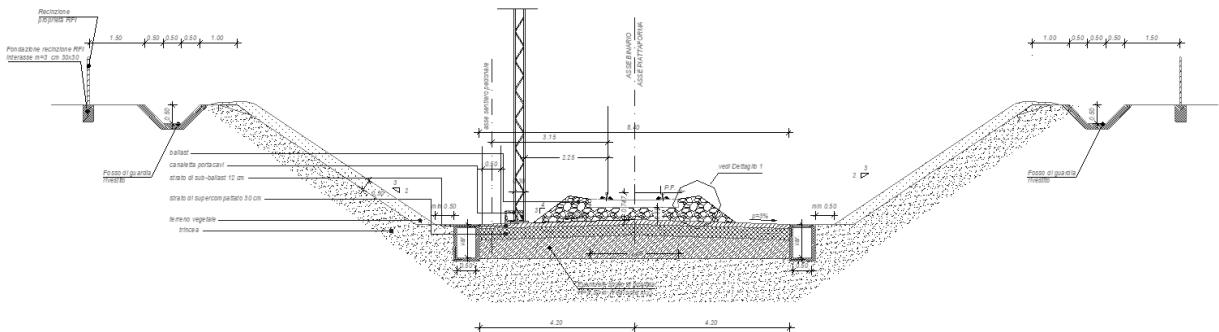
Sezione tipo ferroviaria in trincea a singolo binario in rettilineo
